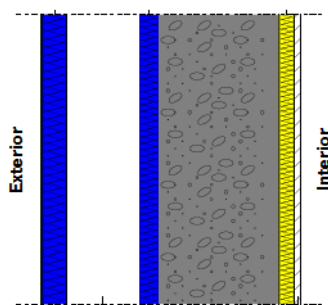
Pormenor das paredes exteriores – Par\_Ext\_2.
